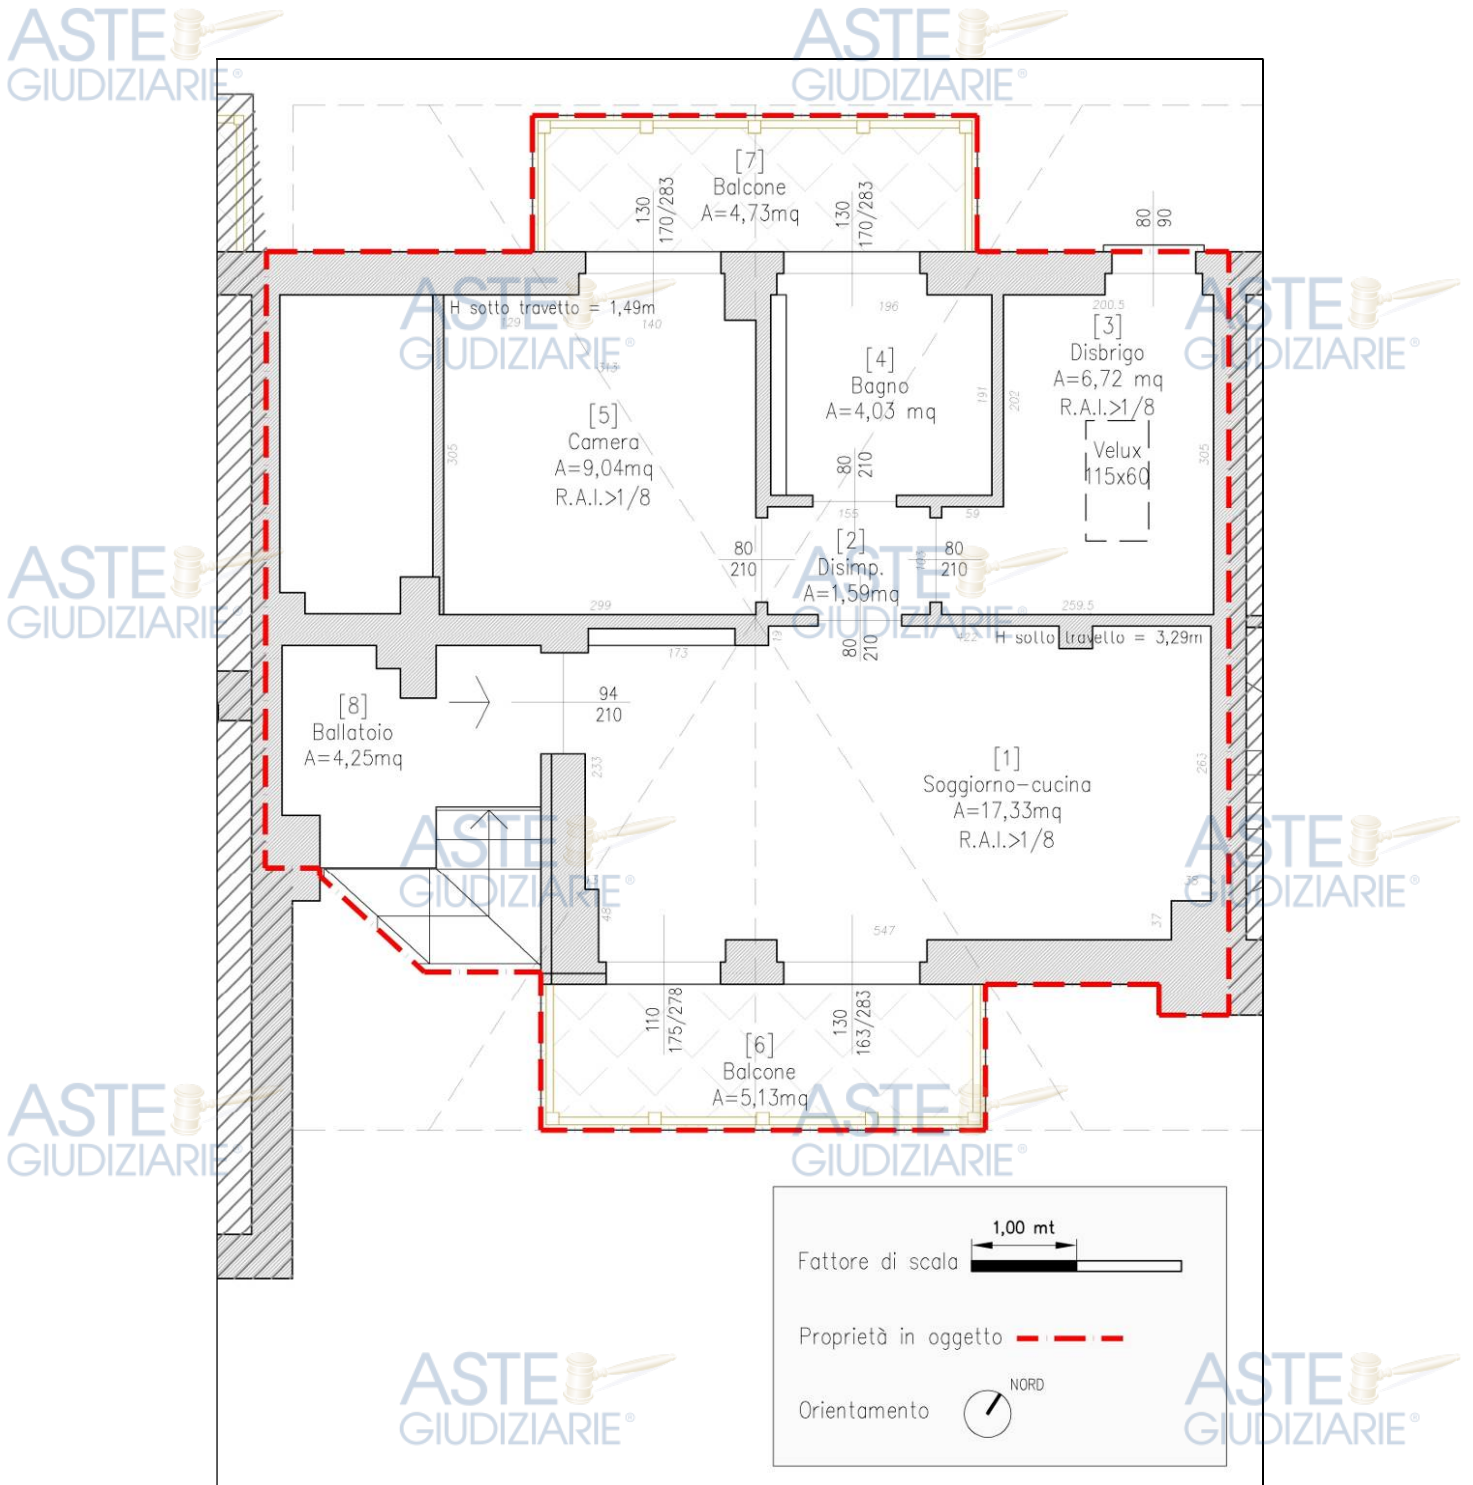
Piano sottotetto - Pianta di rilievo abitazione - Part. 336 sub. 53
